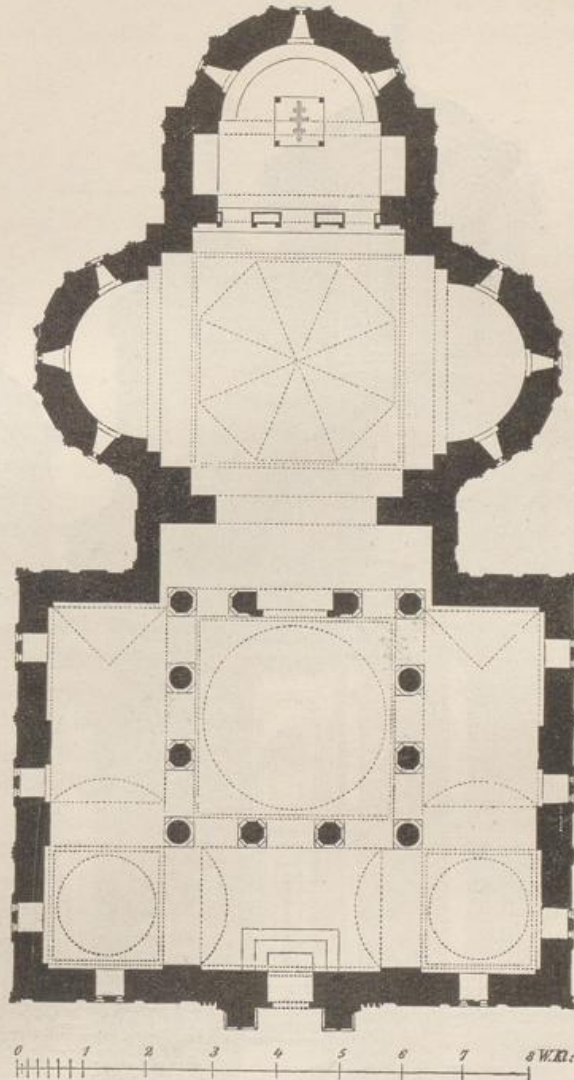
Grundriss der Klosterkirche in Kurtea d'Argyisch.
